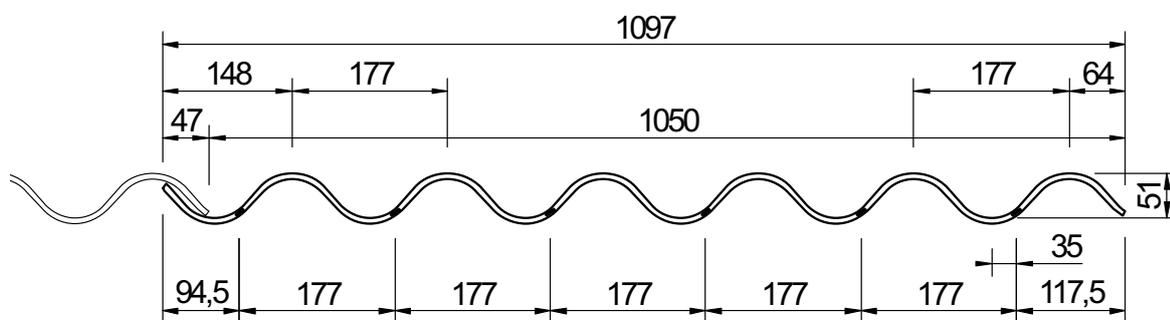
Wellplatte "Eternit Wellplatte" (Profil P6) mit PP-Bändern; Querschnittsabmessung und Lage der PP-Bänder
